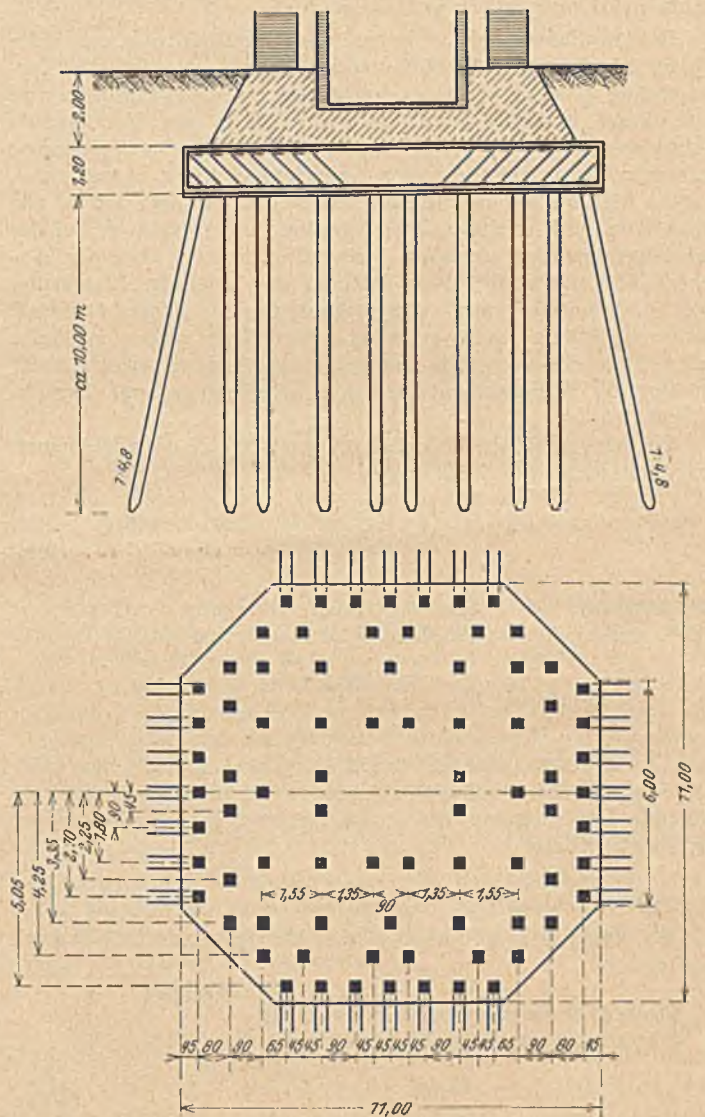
Pfahlrost aus Eisenbetonpfählen unter einem Schornsteinfundament.
